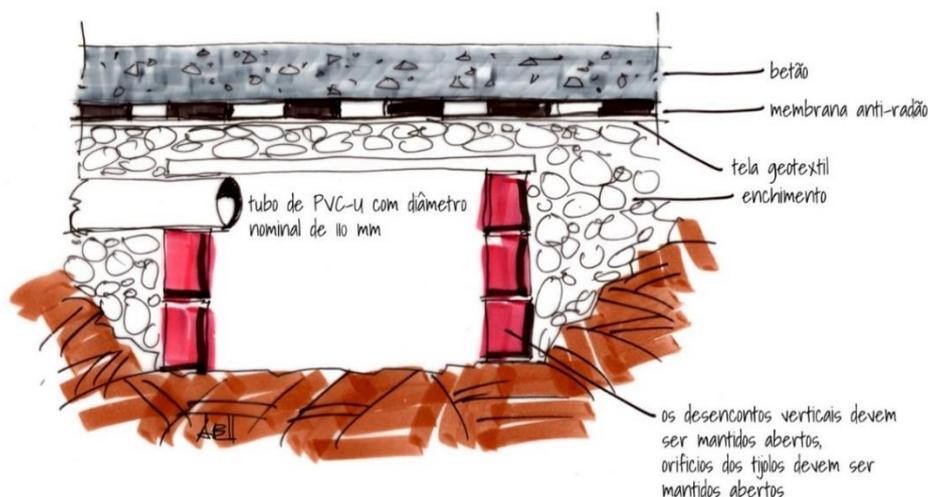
Detalhe construtivo de um sistema de despressurização do terreno debaixo da laje térrea com câmara construída no local da obra
